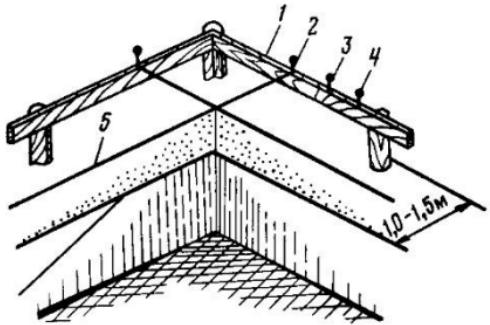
Схема устройства обноски для сооружения фундамента:
